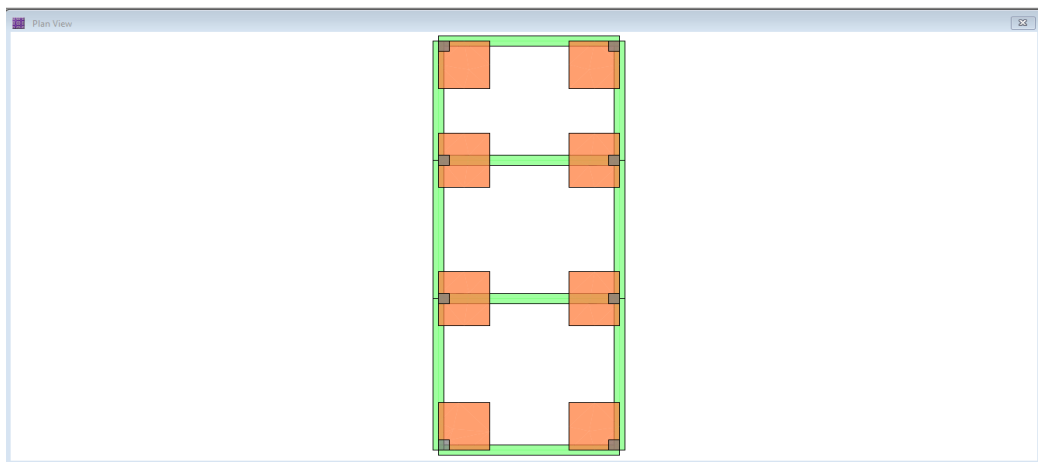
Vista de la cimentación con vigas de conexión en el programa SAFE 2014
